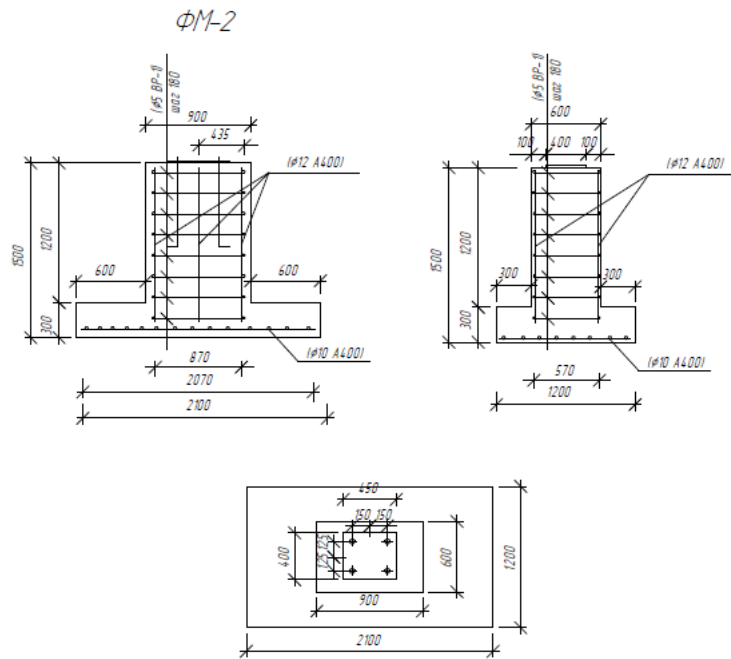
Схема расположения арматурных изделий в фундаментах ФМ2
